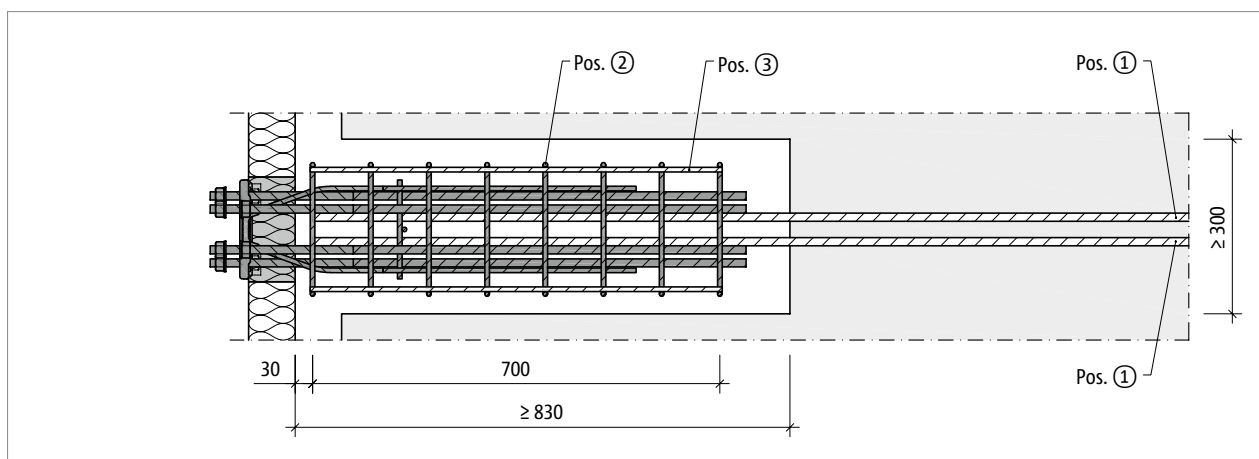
Schöck Isokorb® T type SK-MM1-VV1 : renforcement sur site pour mode de construction semi-préfabriqué, projection horizontale
